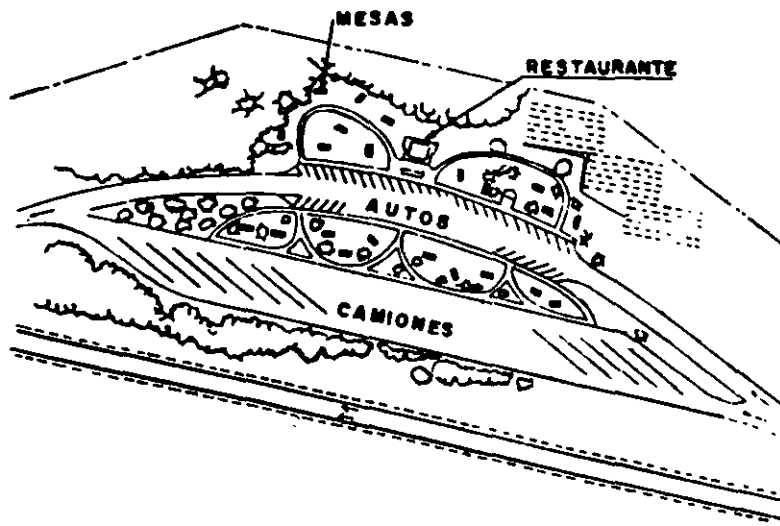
ZONA DE DESCANSO CON DOS AREAS SEPARADAS DE ESTACIONAMIENTO LOCALIZANDO AL FRENTE LA DE CAMIONES
